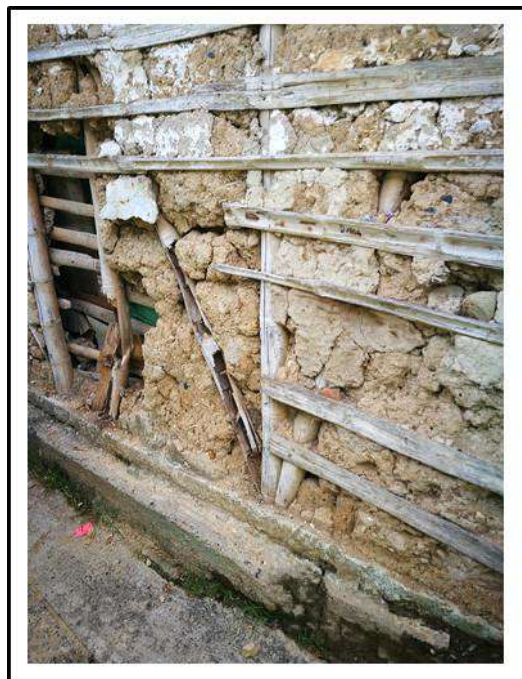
Materiales de construcción de las viviendas ubicadas en el barrio Chavarriaga Wilkins. Elaboración propia.
